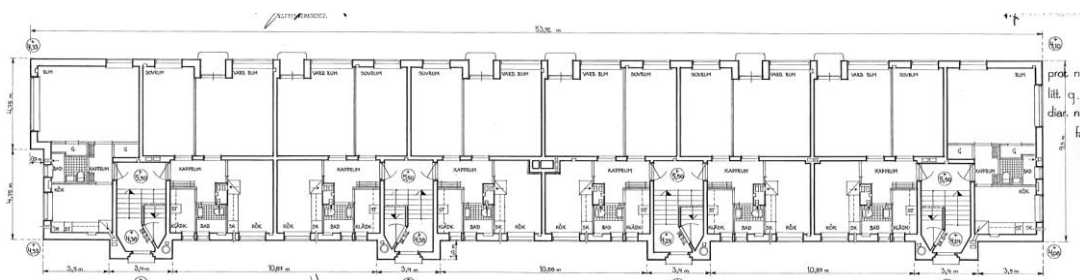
visar Sparvhökens planlösning på plan 1 från 1944.
